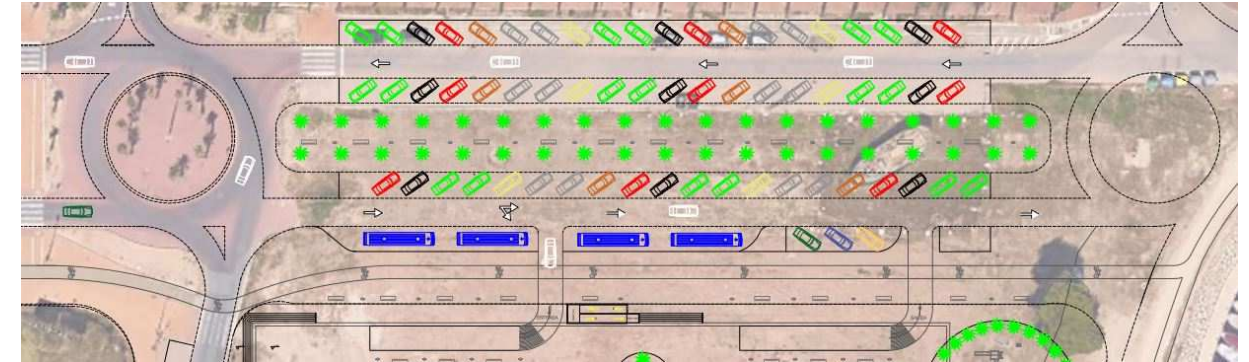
Vista en alzado de la Avenida Augusta urbanizada. Fuente: AutoCad
